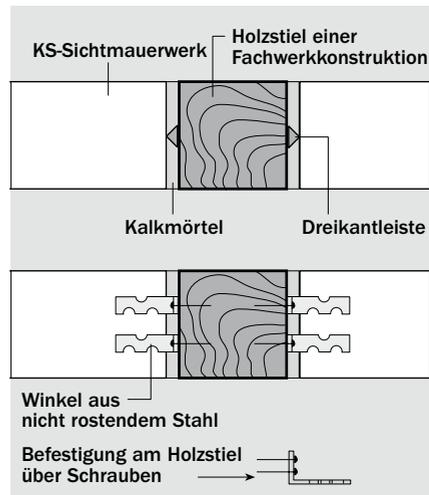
/33: Wandanschluss an eine Holzfachwerkkonstruktion
